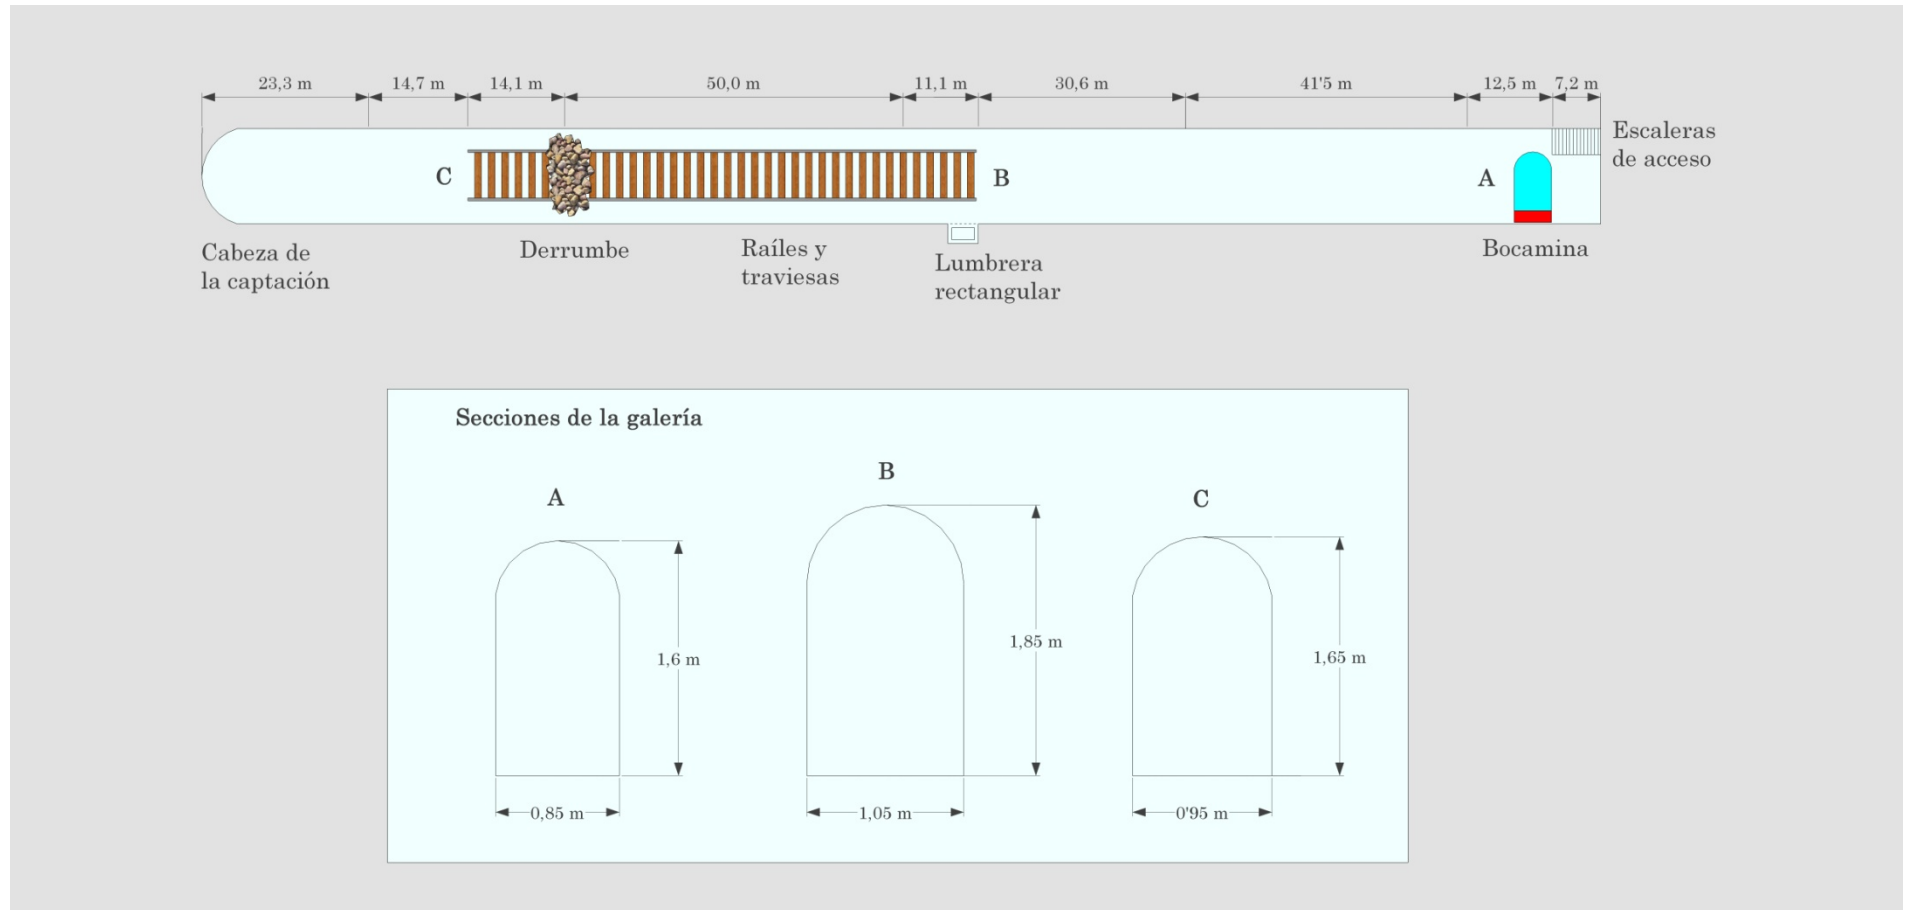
Diseño en planta y secciones de la Mina de San Juan (Biar, Alicante).
